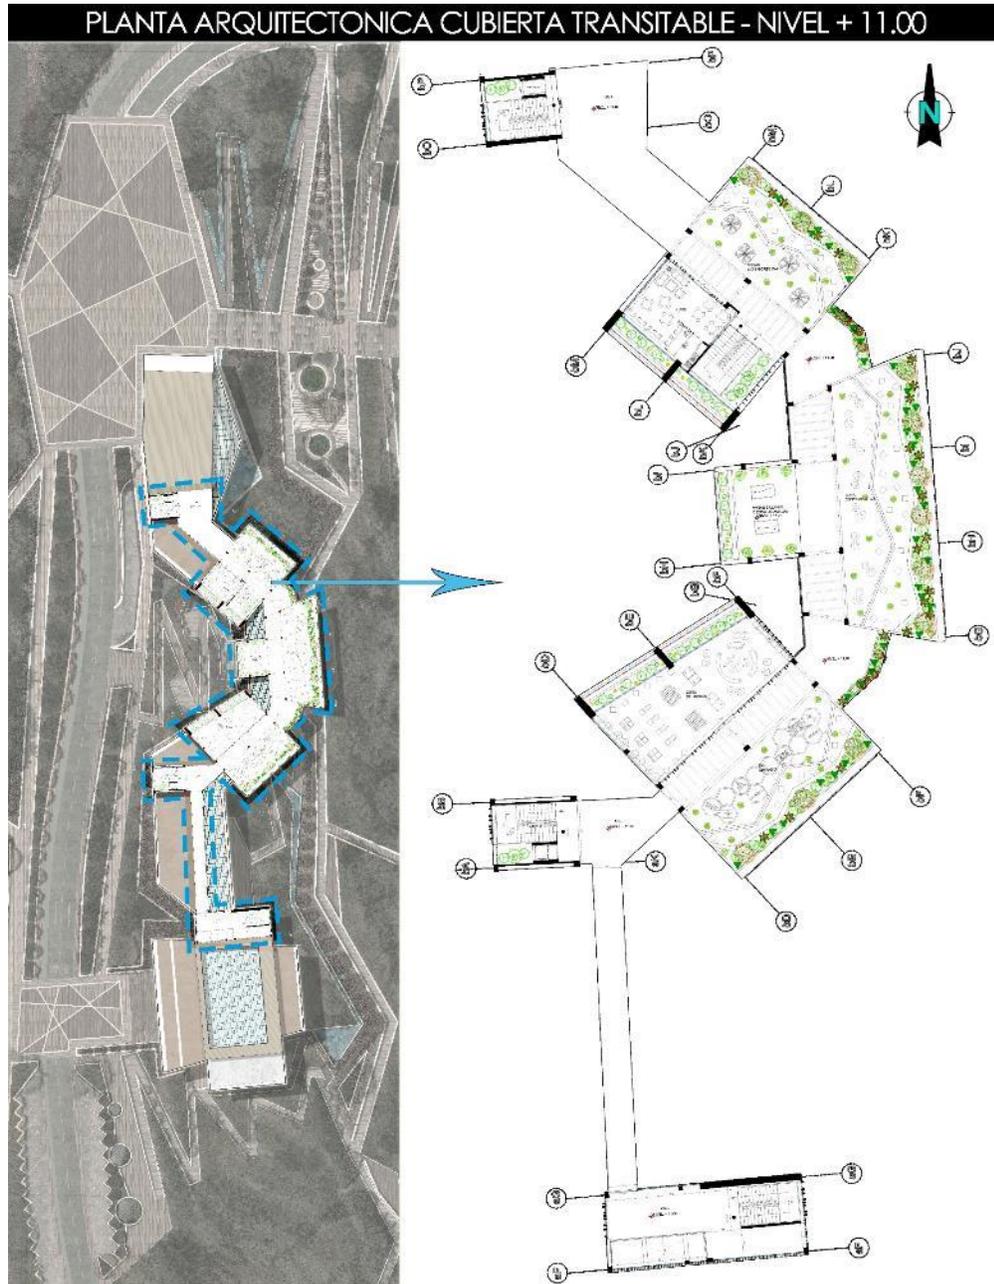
Planta arquitectónica tercer piso - zoom 1.
